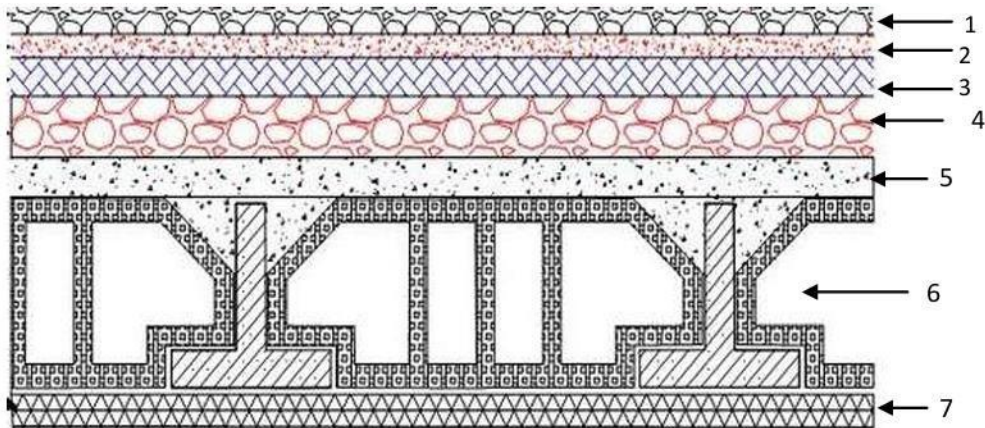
coupe verticale d'un plancher terrasse inaccessible
